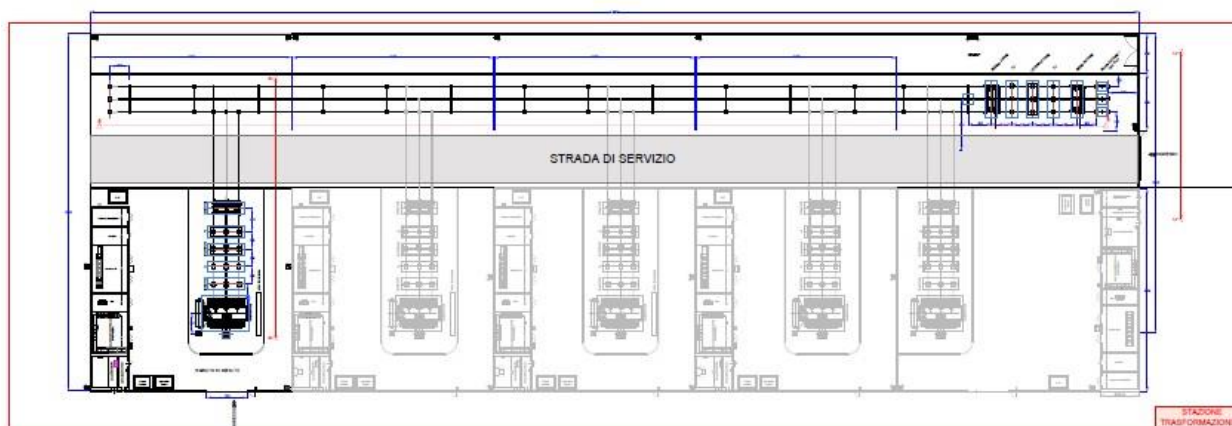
Planimetria della SSE utente di trasformazione 30/150 kV
